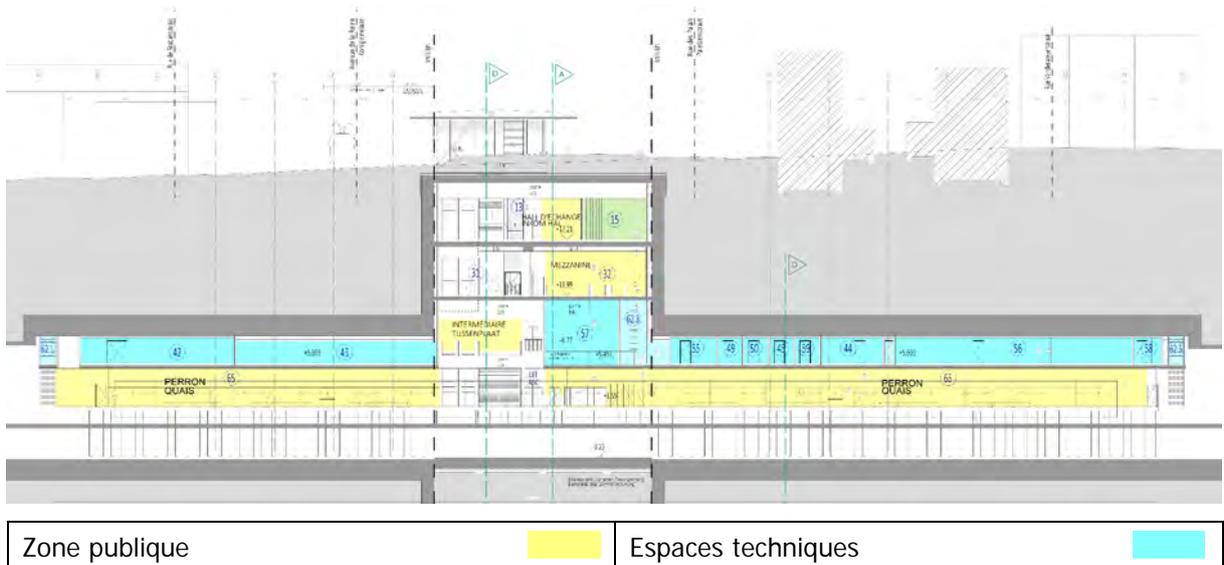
Station Liedts, coupe longitudinale (BMN, 2018)
